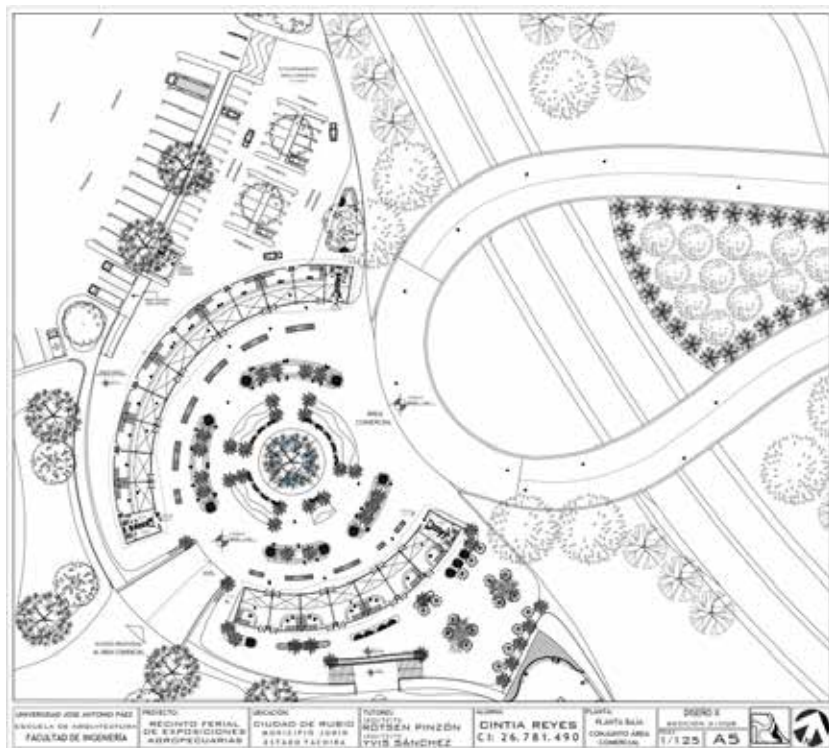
Plano A5, Planta baja conjunto del área comercial. La Autora (2020).
